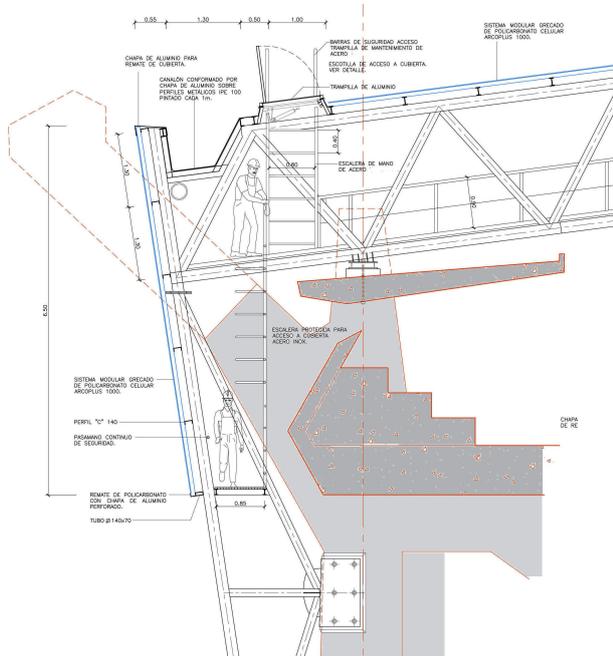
Sección tipo de las pasarelas de mantenimiento en el perímetro exterior de los laterales y acceso a la cubierta. Fuente: elaboración propia.
